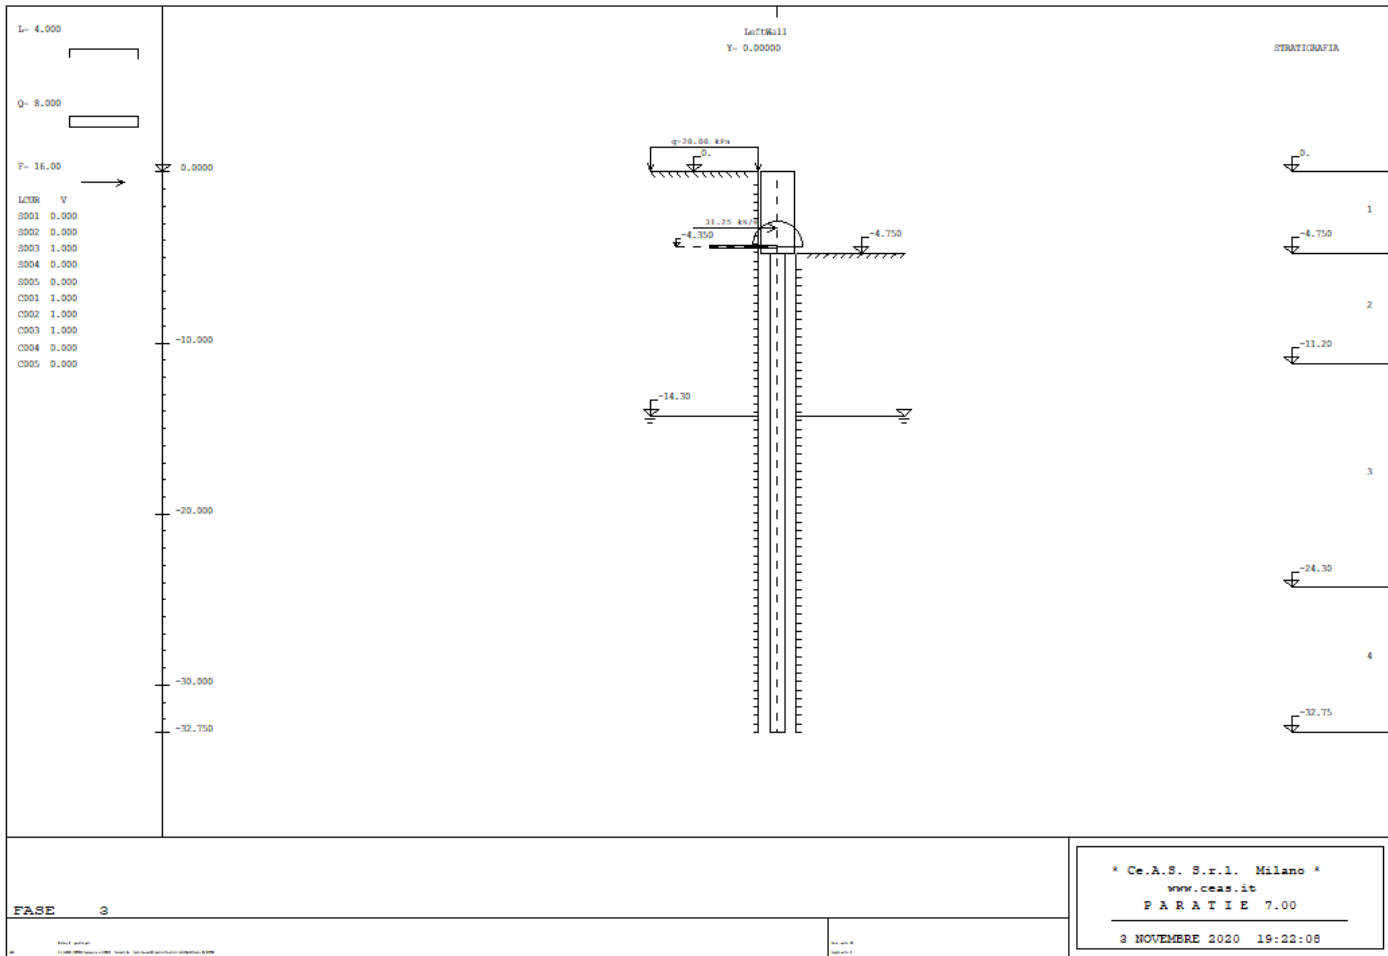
Fase 3 – Applicazione carichi sul rilevato stradale a monte, sugli appoggi e inserimento vincoli traslazionale e rotazionale.
